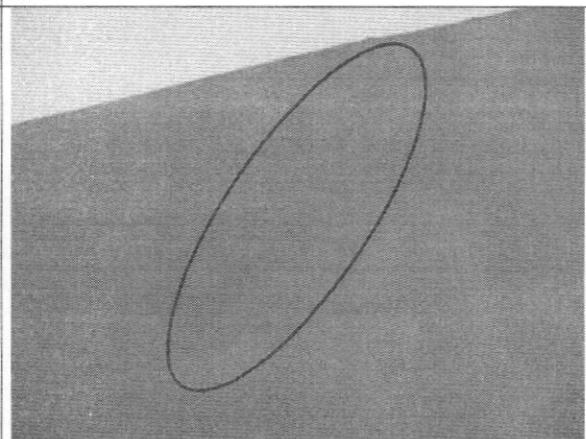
Reparación fisura muro costado oriental, cara exterior.
